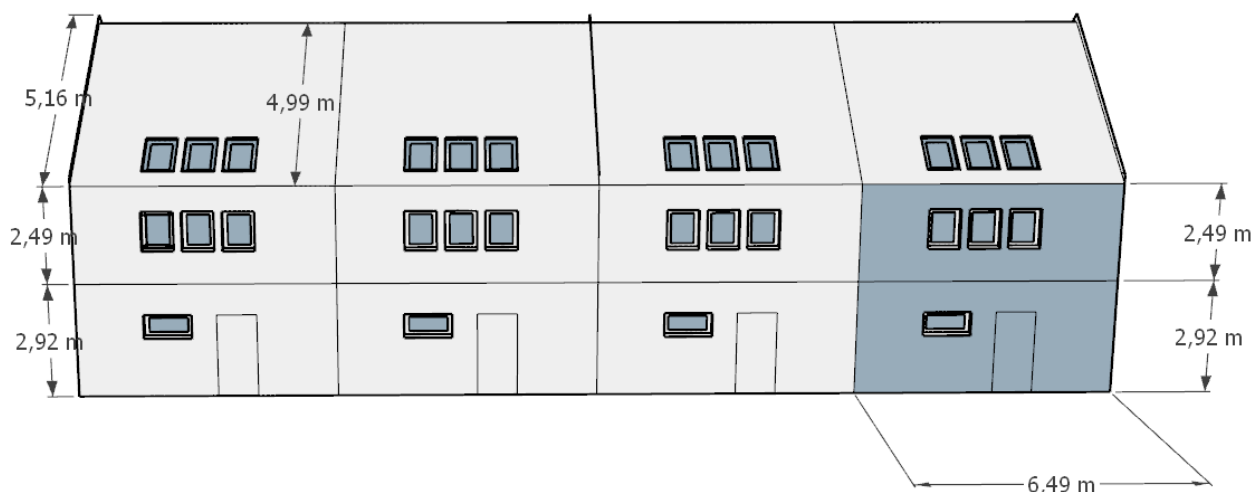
Elewacja północna z widoczną elewacją zachodnią
